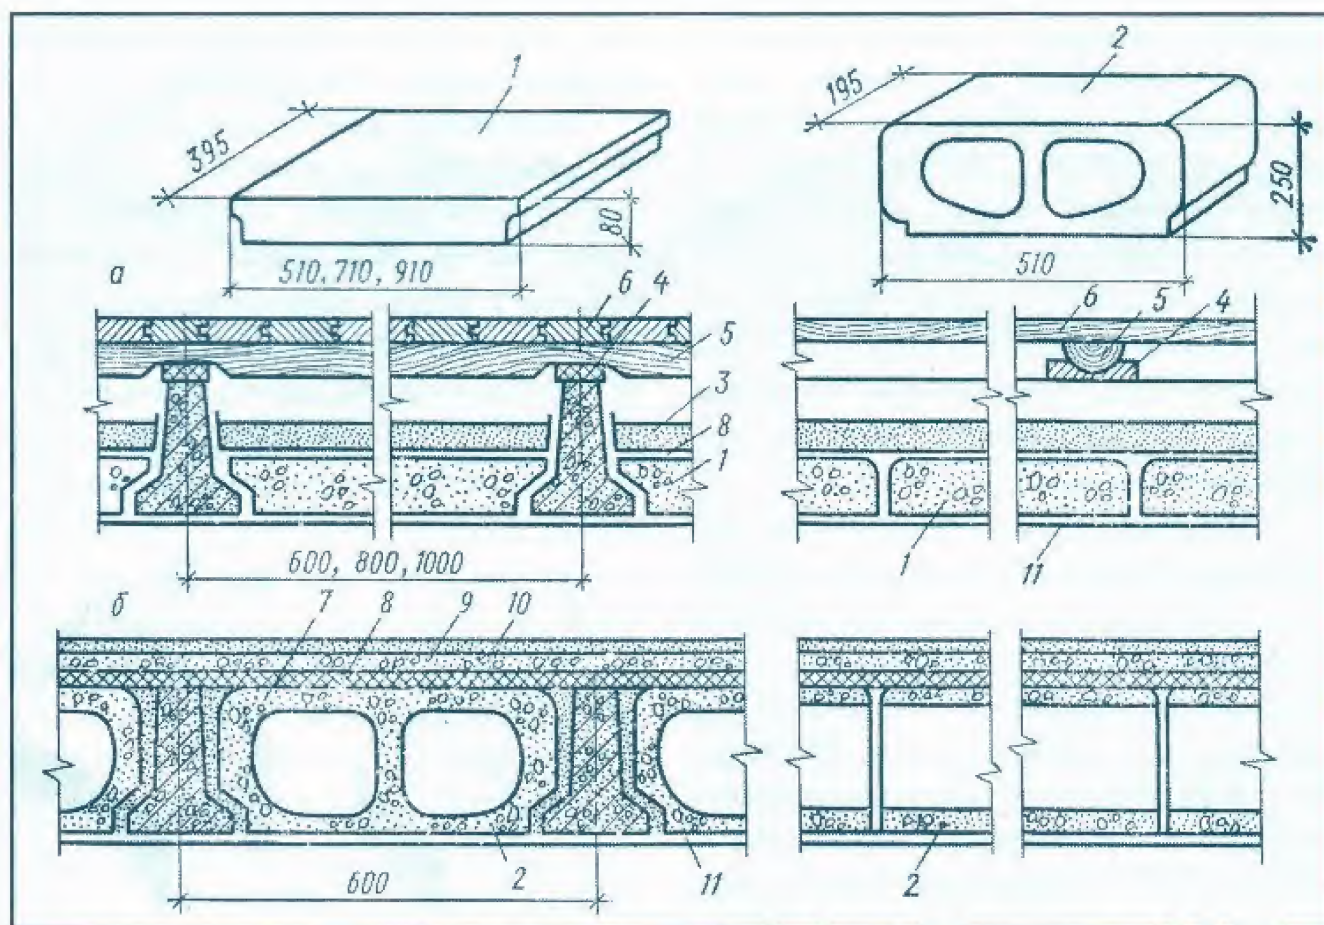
Міжповерхові перекриття по збірних залізобетонних балках: а - з накатом із плит; б - з заповненням вкладишами; 1 - гіпсобетонні плити; 2 - легкобетонні вкладиші; 3 - шлак; 4 - звукоізоляційна прокладка; 5 - лага; 6 - дерев'яна підлога; 7 - оргаліт; 8 - толь; 9 - легкий бетон; 10 - чиста підлога (мінеральна); 11 - затирка.
